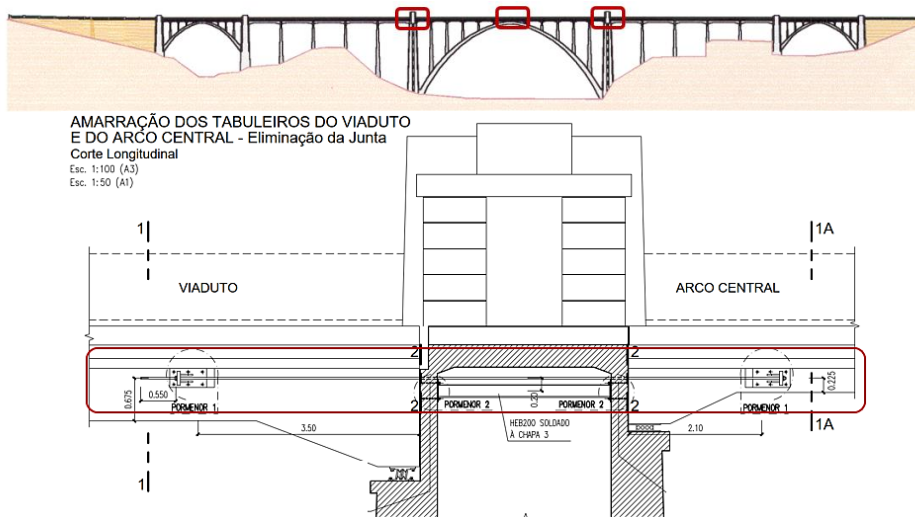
Ligação dos tabuleiros à pilastra com varões de pré-esforço.
